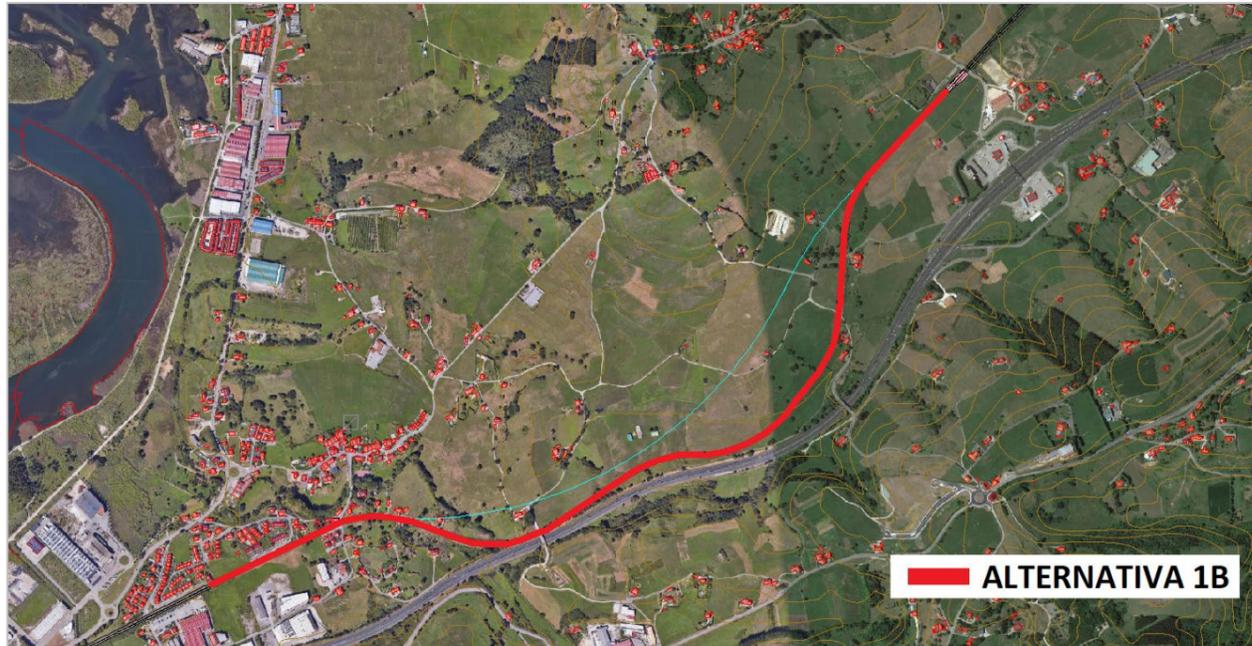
Trazado en planta de la alternativa 1B. Fuente: Istram
